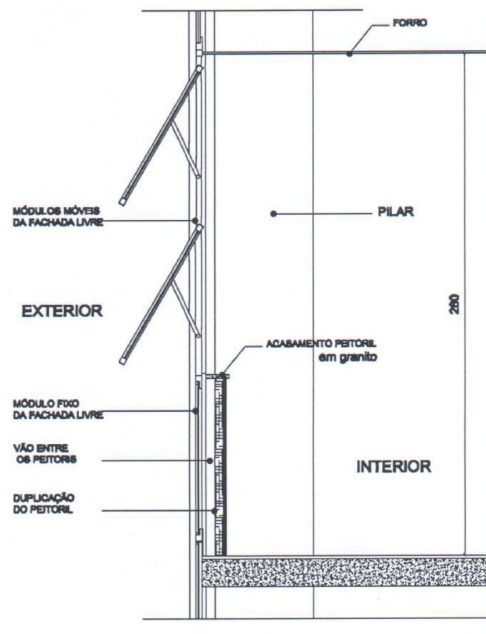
Detalhe fachada Leste – corte transversal – 2016
